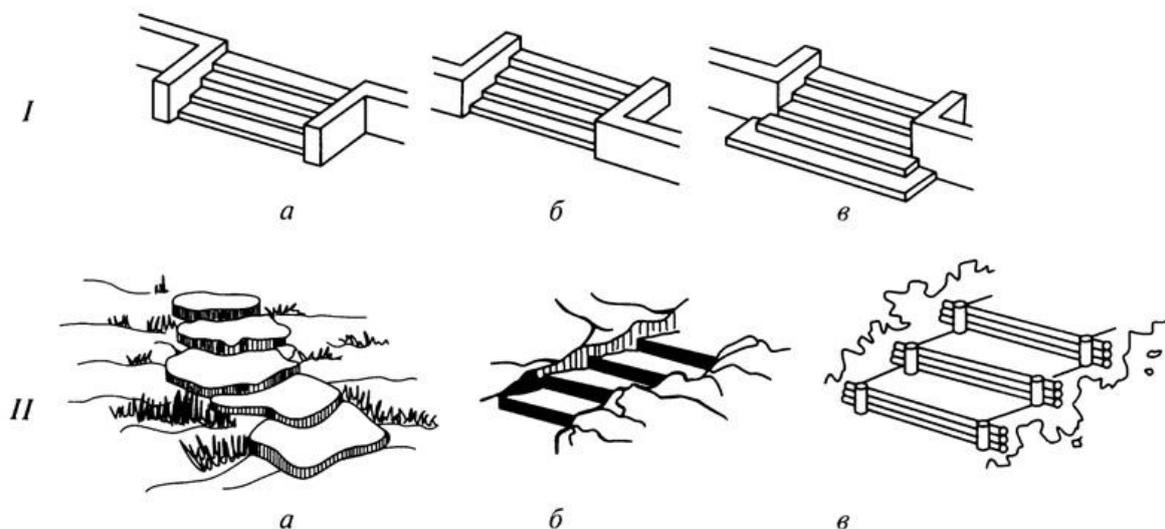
Лестницы в сочетании с подпорной стенкой (I — лестницы с подпорными стенками: а — в насыпи; б — в выемке; в — в полунасыпи-полувыемке; II — лестницы без подпорных стенок: а — ступени-плиты, лежащие на поверхности откоса; б — ступени, врезанные в склон; в — ступени, сформированные локальной подсыпкой грунта)
